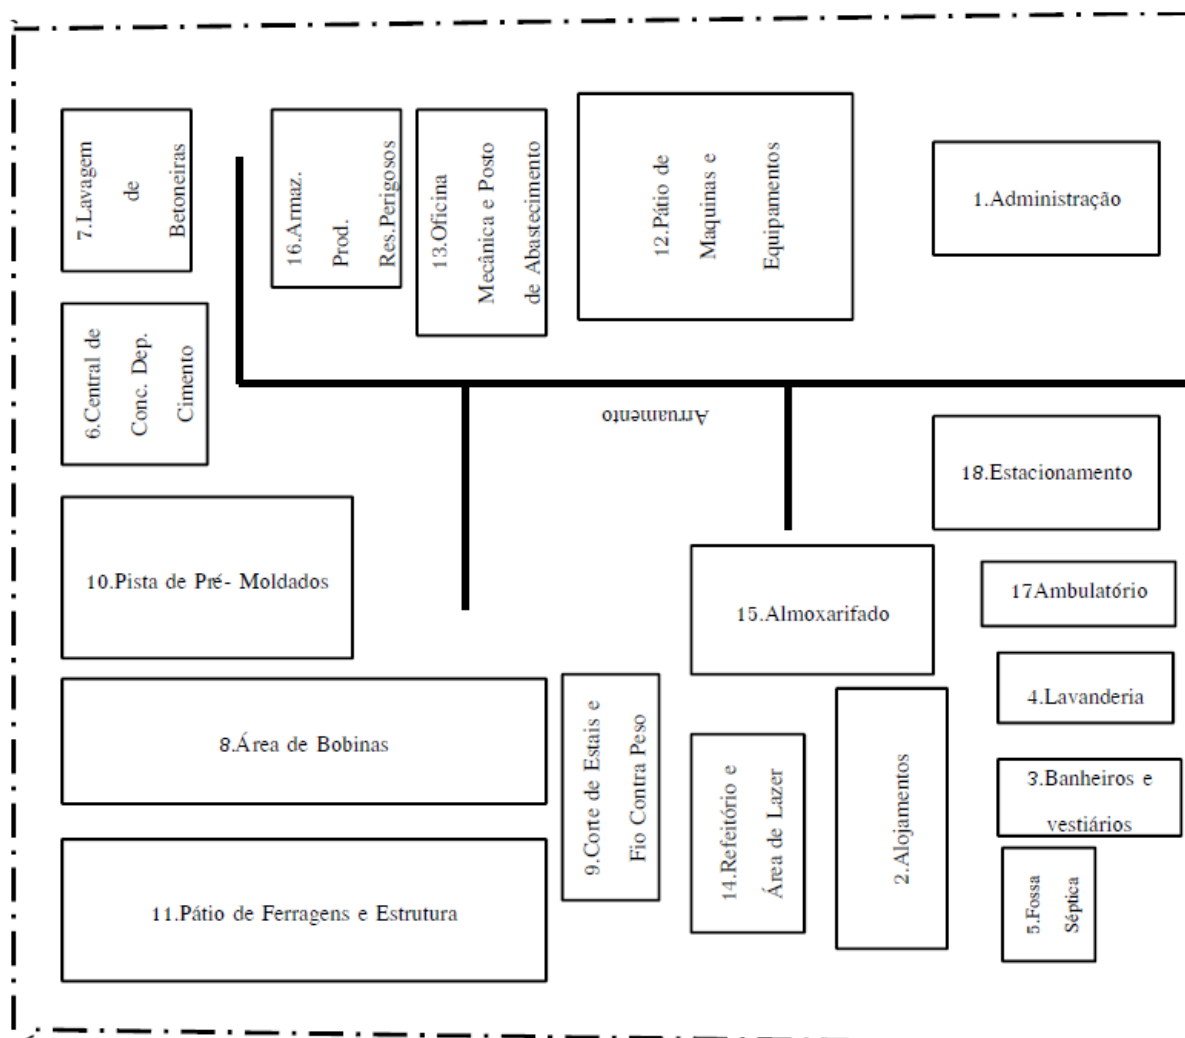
Layout típico do Canteiro de Obra do empreendimento.
